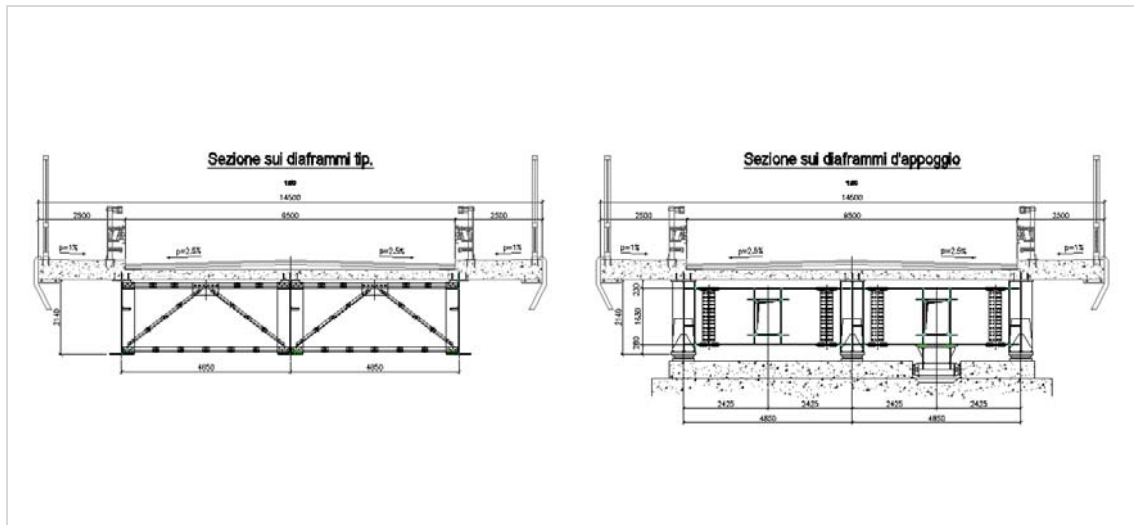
Sezione trasversale dell’impalcato in corrispondenza di un tipico traverso reticolare e di un traverso in corrispondenza delle spalle o di una pila intermedia.
